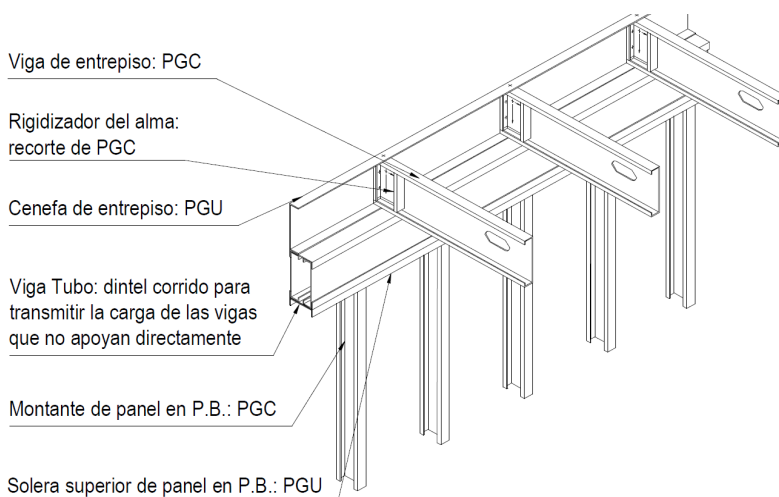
Forjado donde las vigas no coinciden linealmente con los montantes, debiendo construirse una viga tubo.
